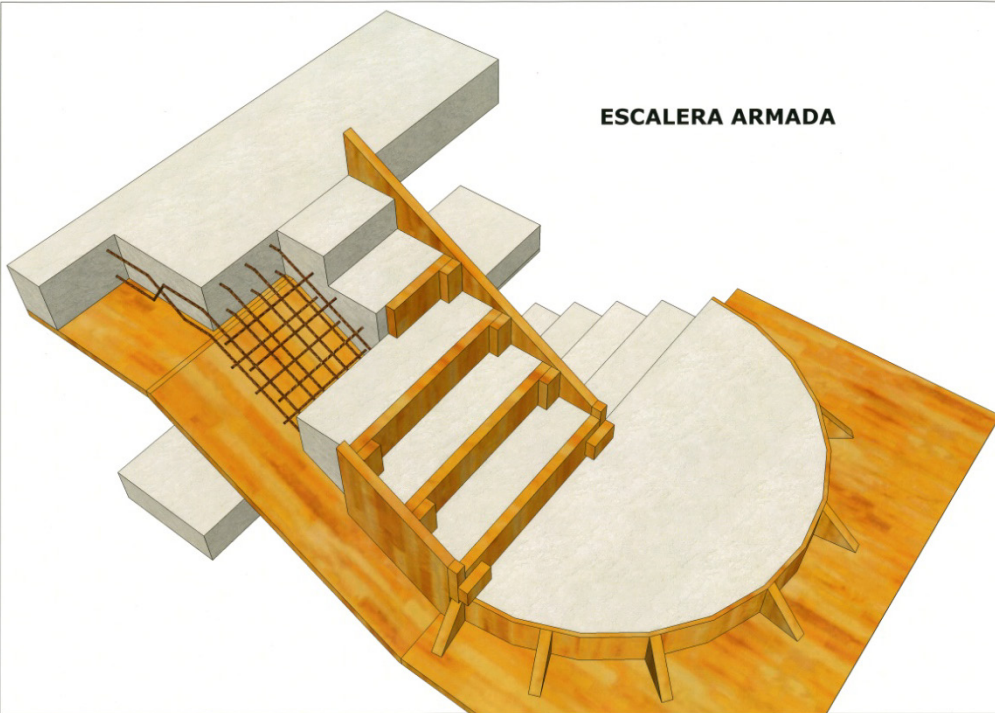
Ejecución de losa peldañeada de hormigón armado. Modelado en 3D.
